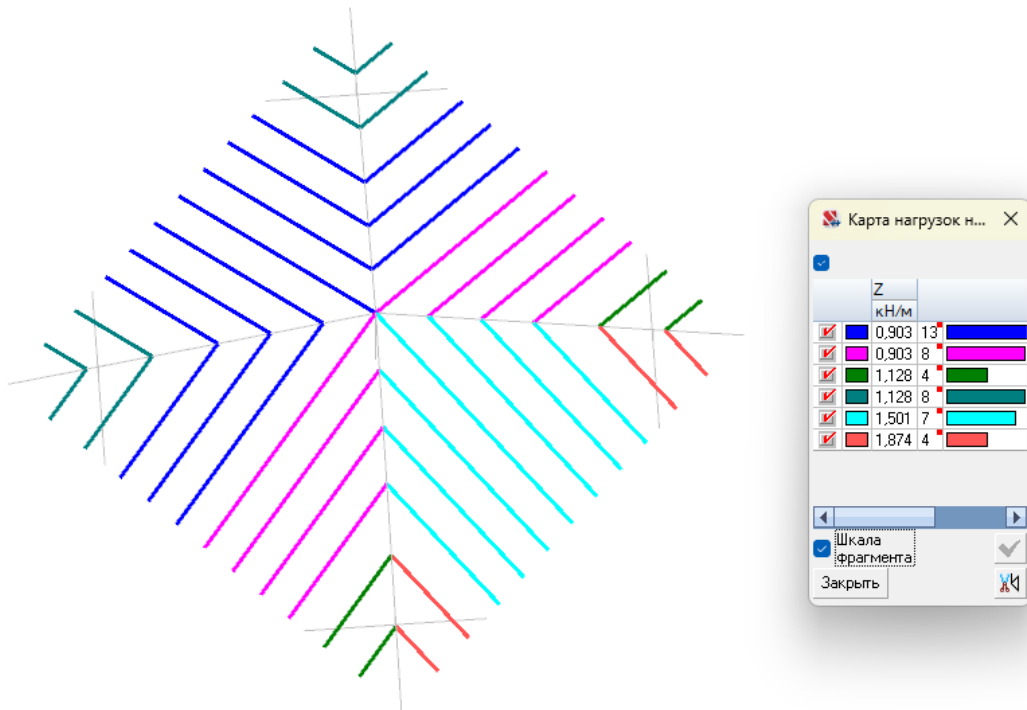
Снеговая нагрузка вариант 2
